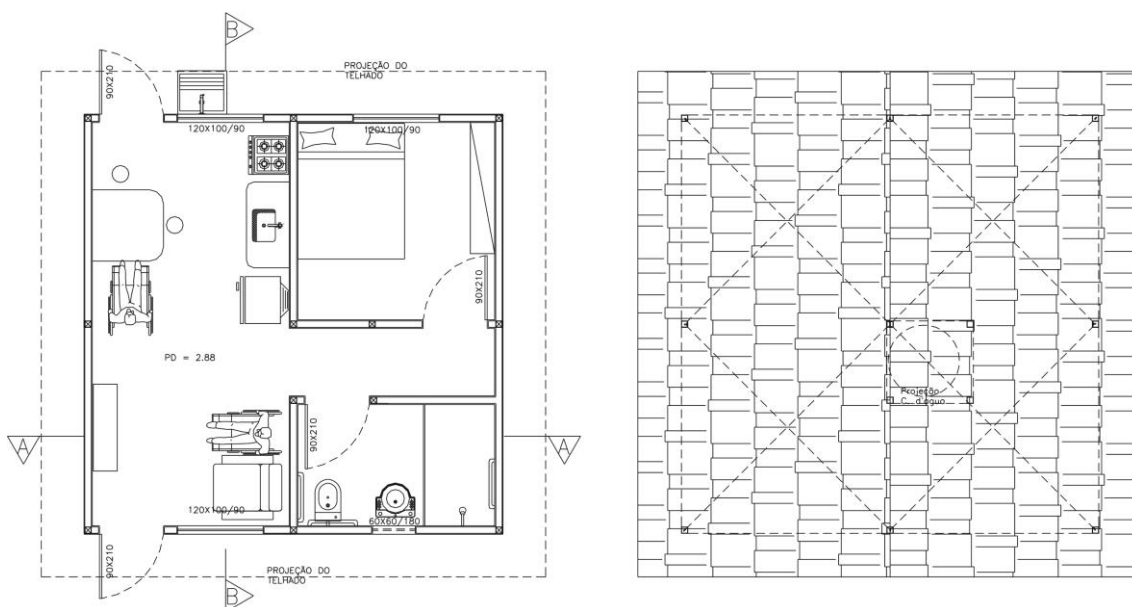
Planta e planta de cobertura – Modelo arquitetônico 34,69 m².
